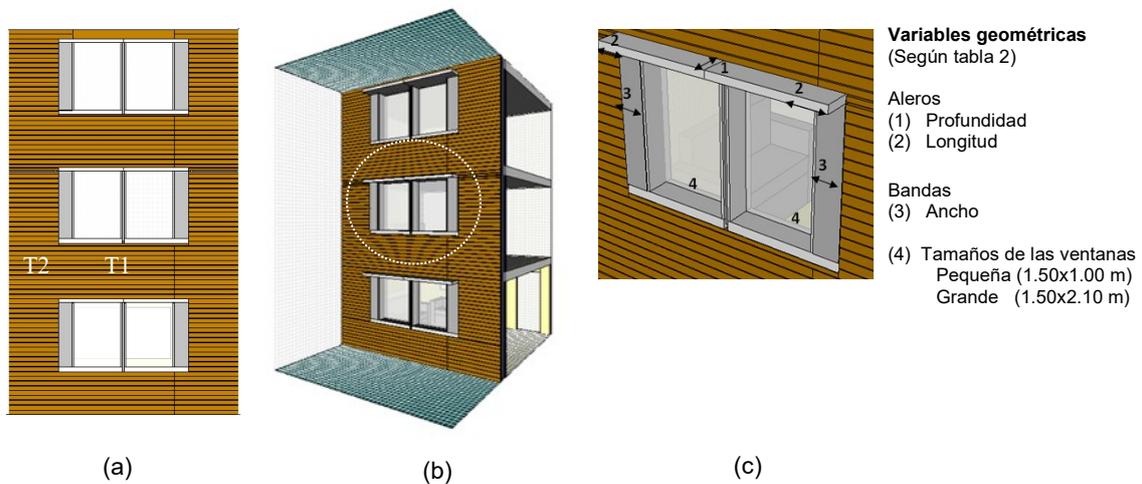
(a) Ubicación de termopares (vista frontal) (b) Ubicación de las ventanas y los elementos de fachada (vista isométrica) (c) Detalle de los elementos de la fachada estudiados
